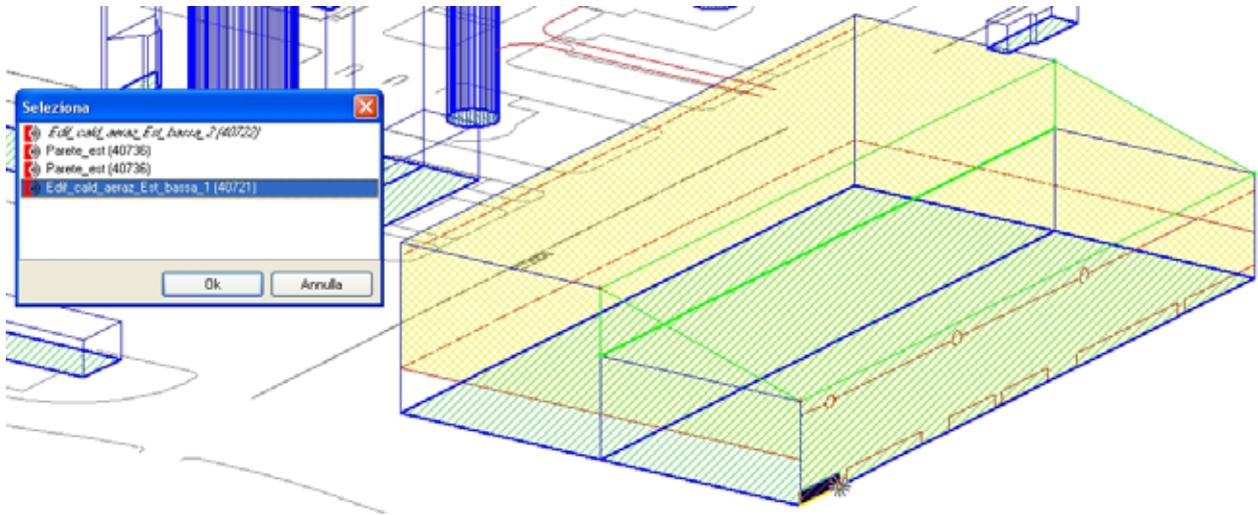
Nuovo edificio generatori di calore, porzione 1 ventilazione parete Est.
